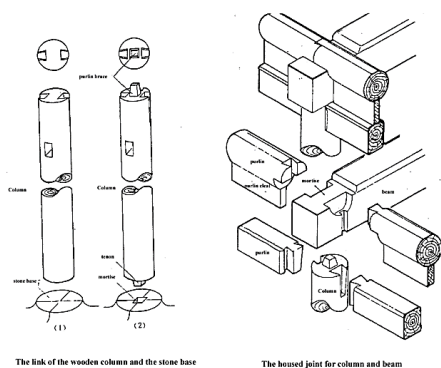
Ligações entre elementos na construção Chinesa (Zhang, 2000).
